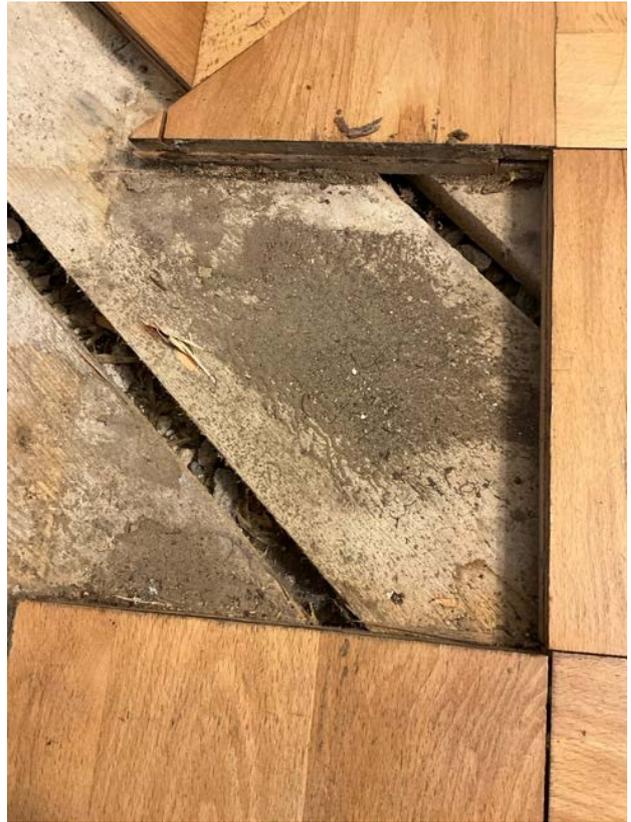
Schlackenstaub in Hohlräumen unter Parkett
